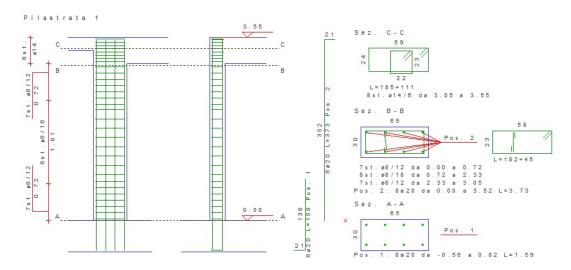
PILASTRO N. 1, 6, 7, 12
